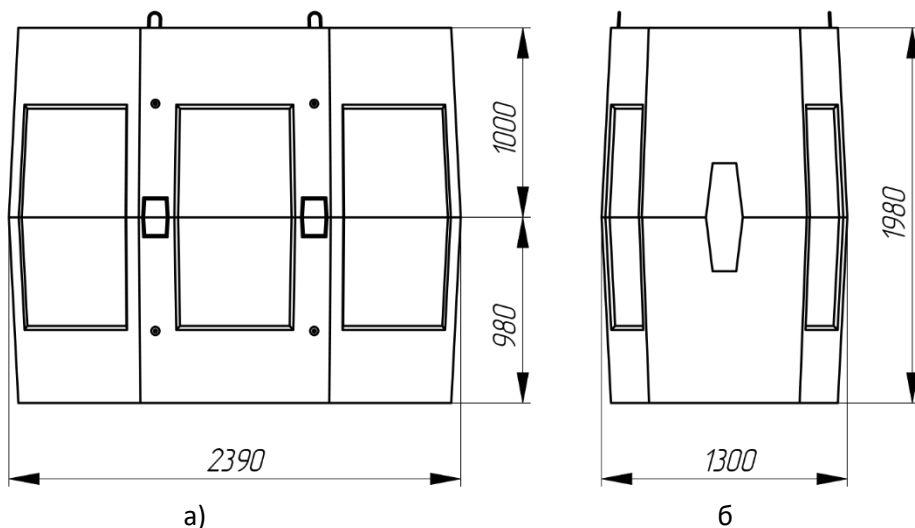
Габаритные размеры колодца «ККСр-4-10»: а - вид сбоку; б – вид с торца.
